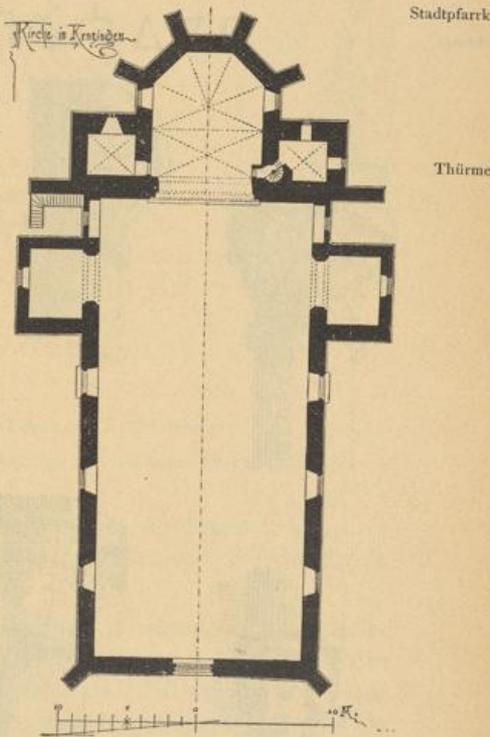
Kenzingen. Pfarrkirche, Grundriss.
